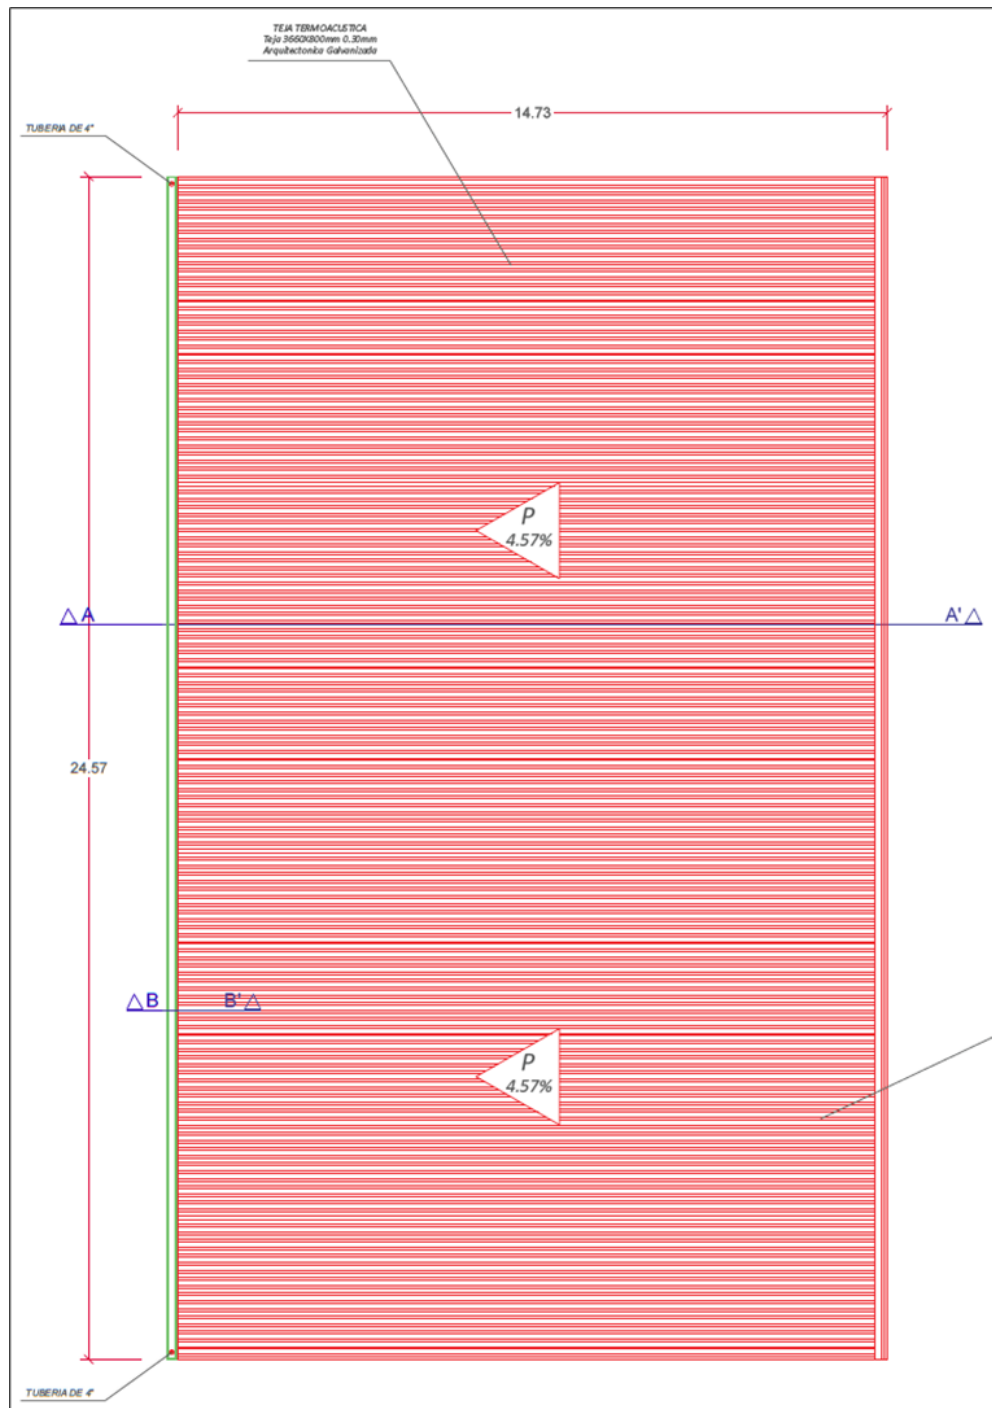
Vista en planta de tejado de la estructura 1 del Centro vida.
